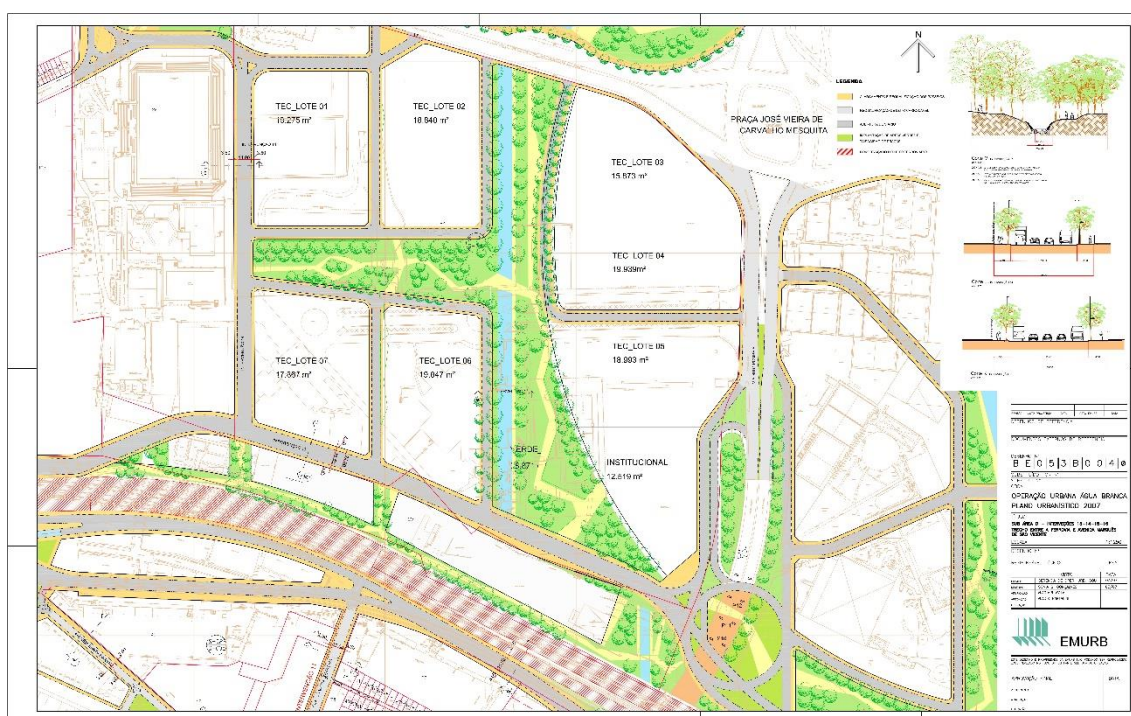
Detalhe da gleba da TELESP na Primeira versão do Plano Urbanístico desenvolvido pela EMURB em março de 2007. Fonte: Biblioteca da SP Urbanismo (2022).
